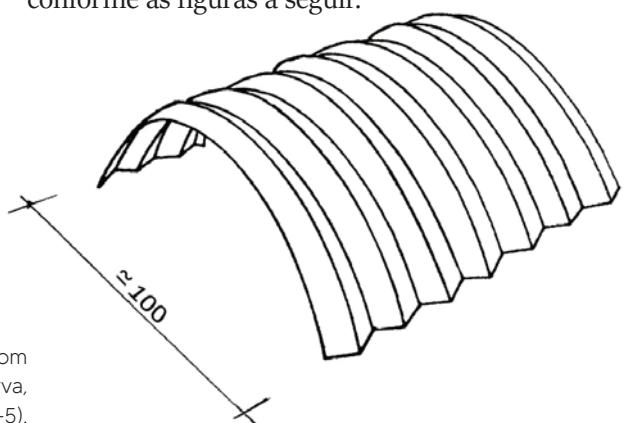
Hangar com cobertura plissada curva, em tijolo armado. (*-5).
